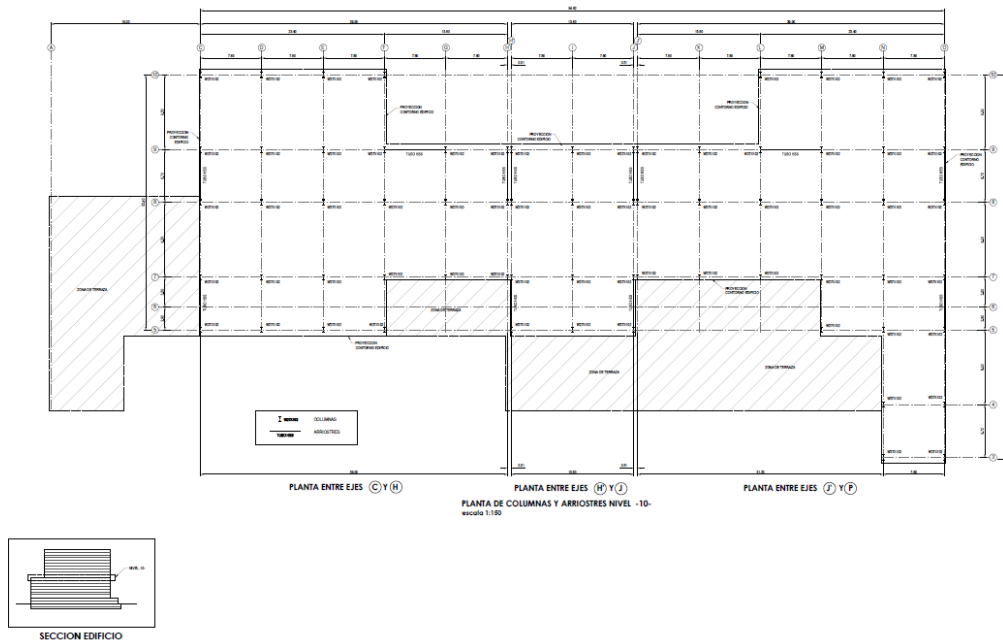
Planta Estructural Columnas, Muros y Arriostres. Nivel 10
